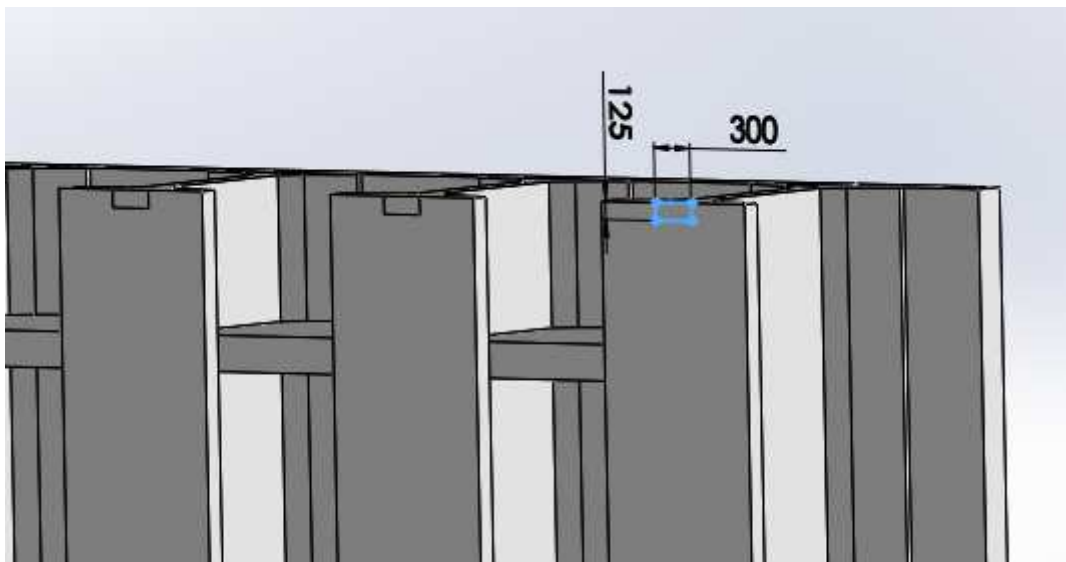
Croquis de la línea de partición correspondiente a la sección de apoyo de las vigas (cotas en mm), SolidWorks.
